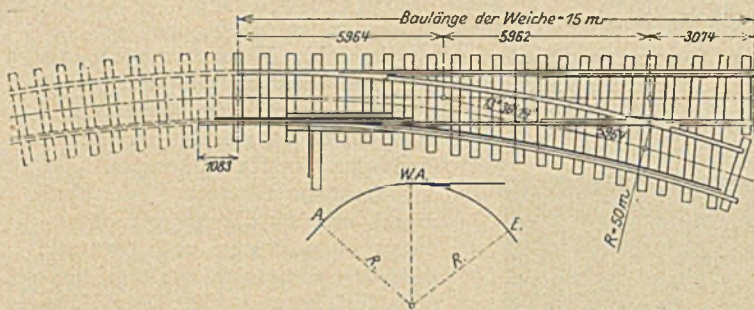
Einzungenweiche mit Spurkranzauf lauf.
